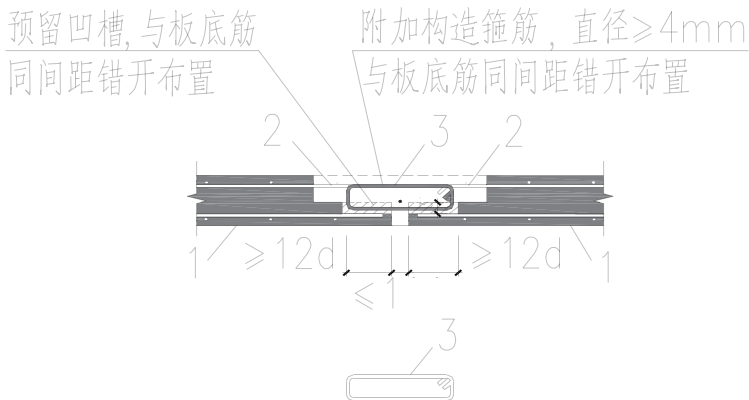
变阶预制混凝土单向板拼缝构造示意图
